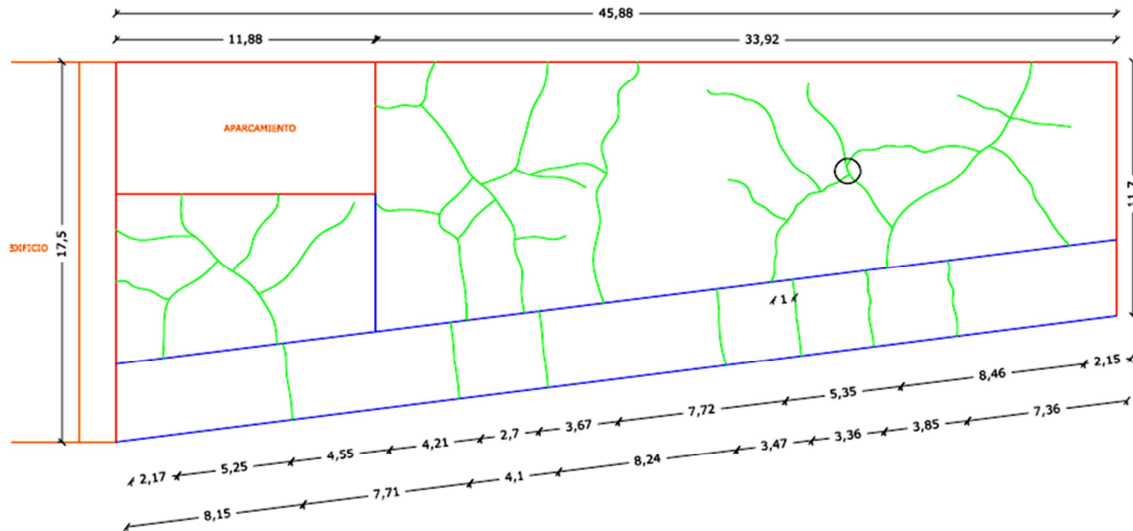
45 –Levantamiento plano de fisuras en losa de 380 m<sup>2</sup> (Fecha:27.05.2014)
